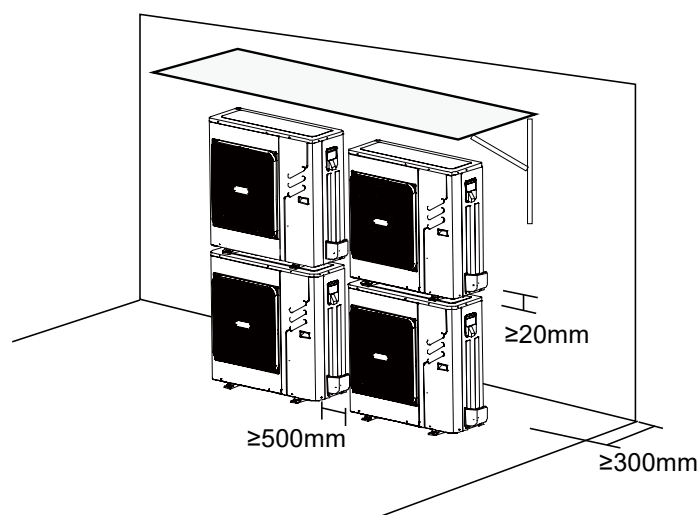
Instalacja z przeszkodami przed urządzeniem
